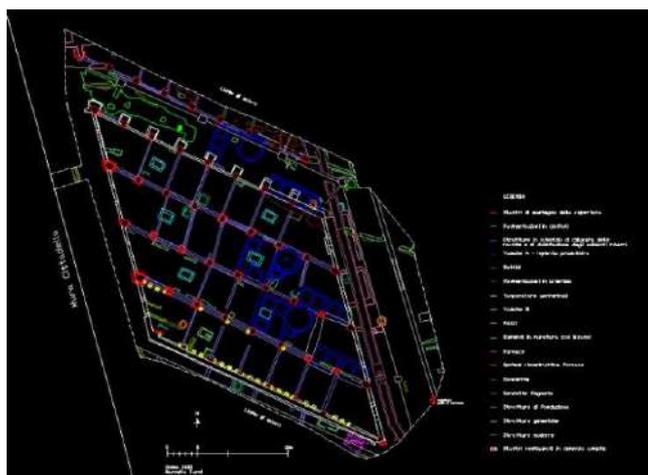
Vista Pisa. Arsenali repubblicani. Planimetria
